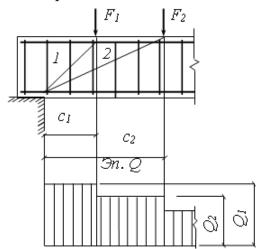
Расположение расчетных наклонных сечений при сосредоточенных силах: 1 - наклонное сечение проверяемое на действие поперечной силы Q_1 ; 2 - то же, силы Q_2
